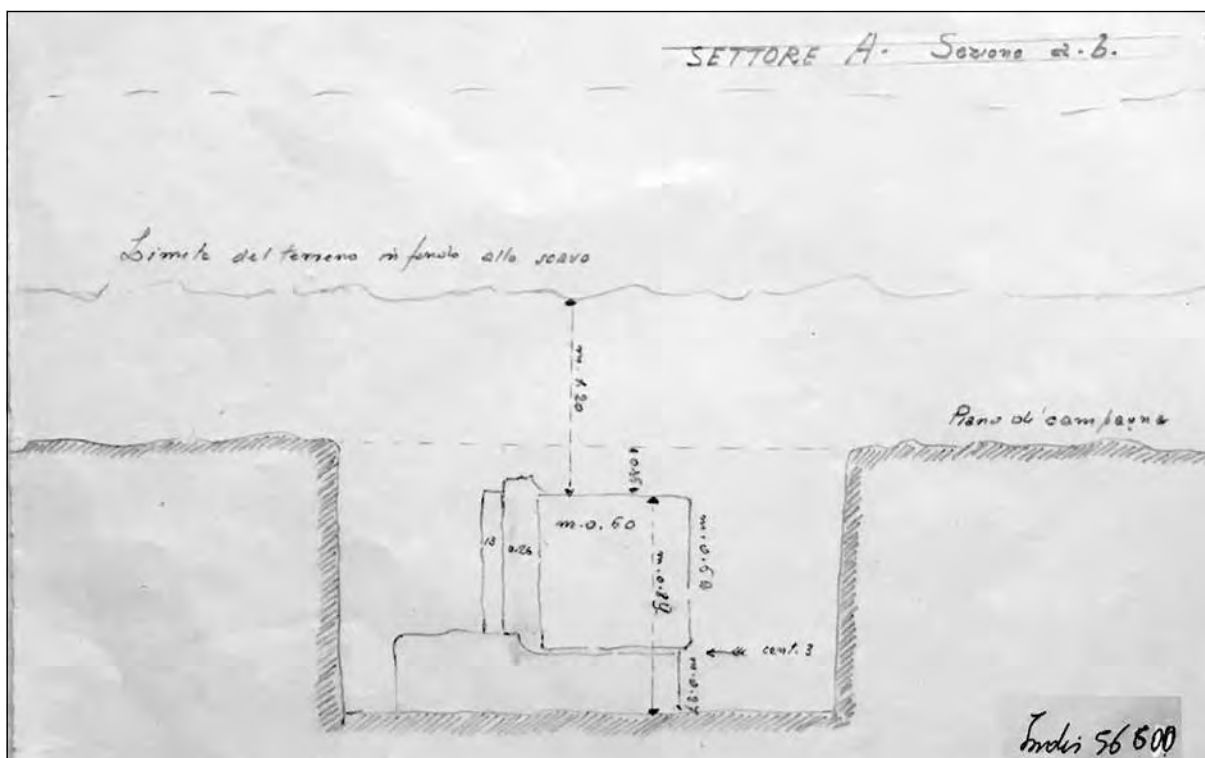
Sezione del muraglione di contenimento del portico (A.SABAP-M.).
